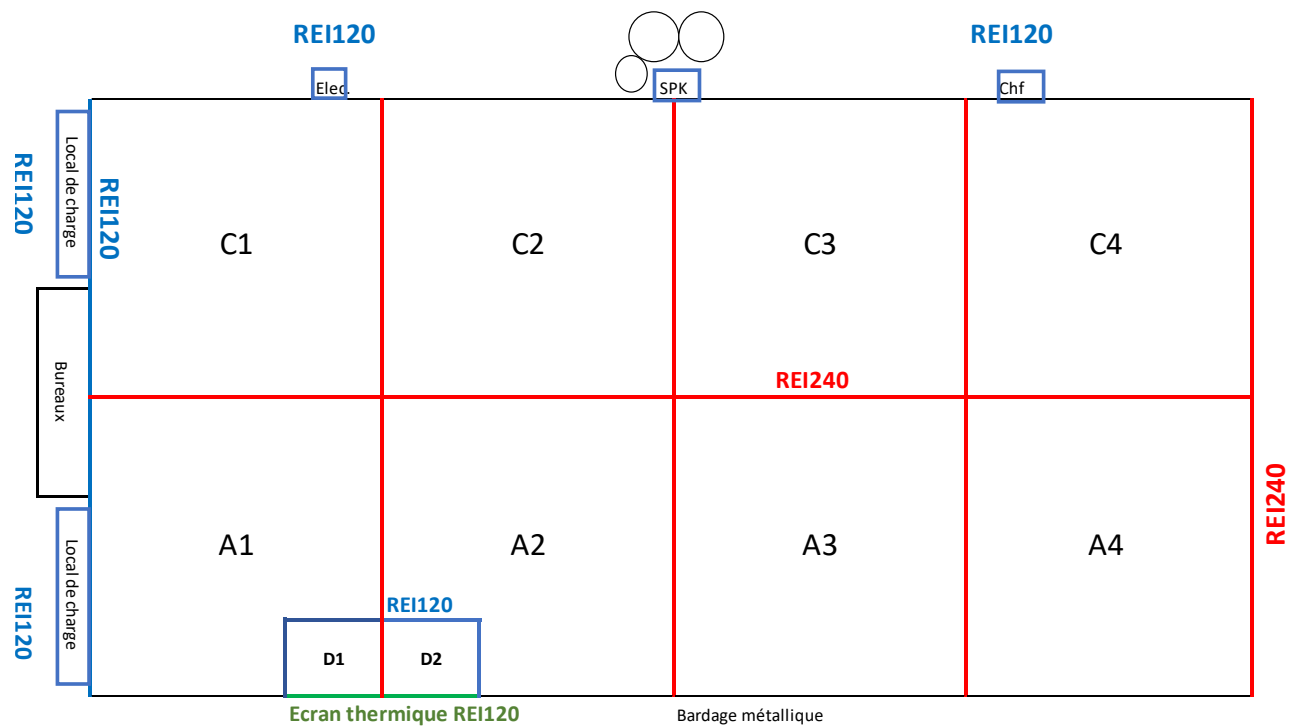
Recouplement du bâtiment, écrans et murs coupe-feu
